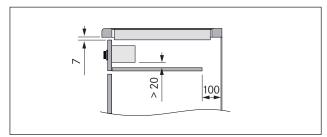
Vista laterale piano di protezione cavi e aerazione
